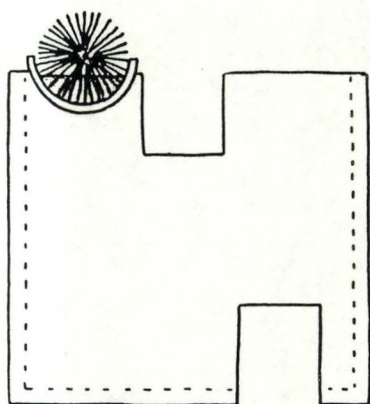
Brosse pour anguilles installée sur une passe à bassins de type mixte (d'après JENS, 1982).
